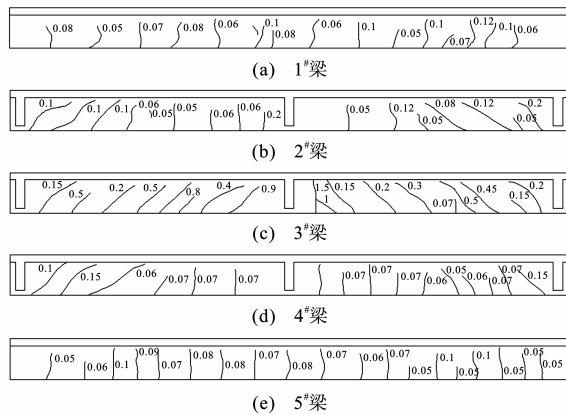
钢筋混凝土T梁裂缝分布(单位:mm)
